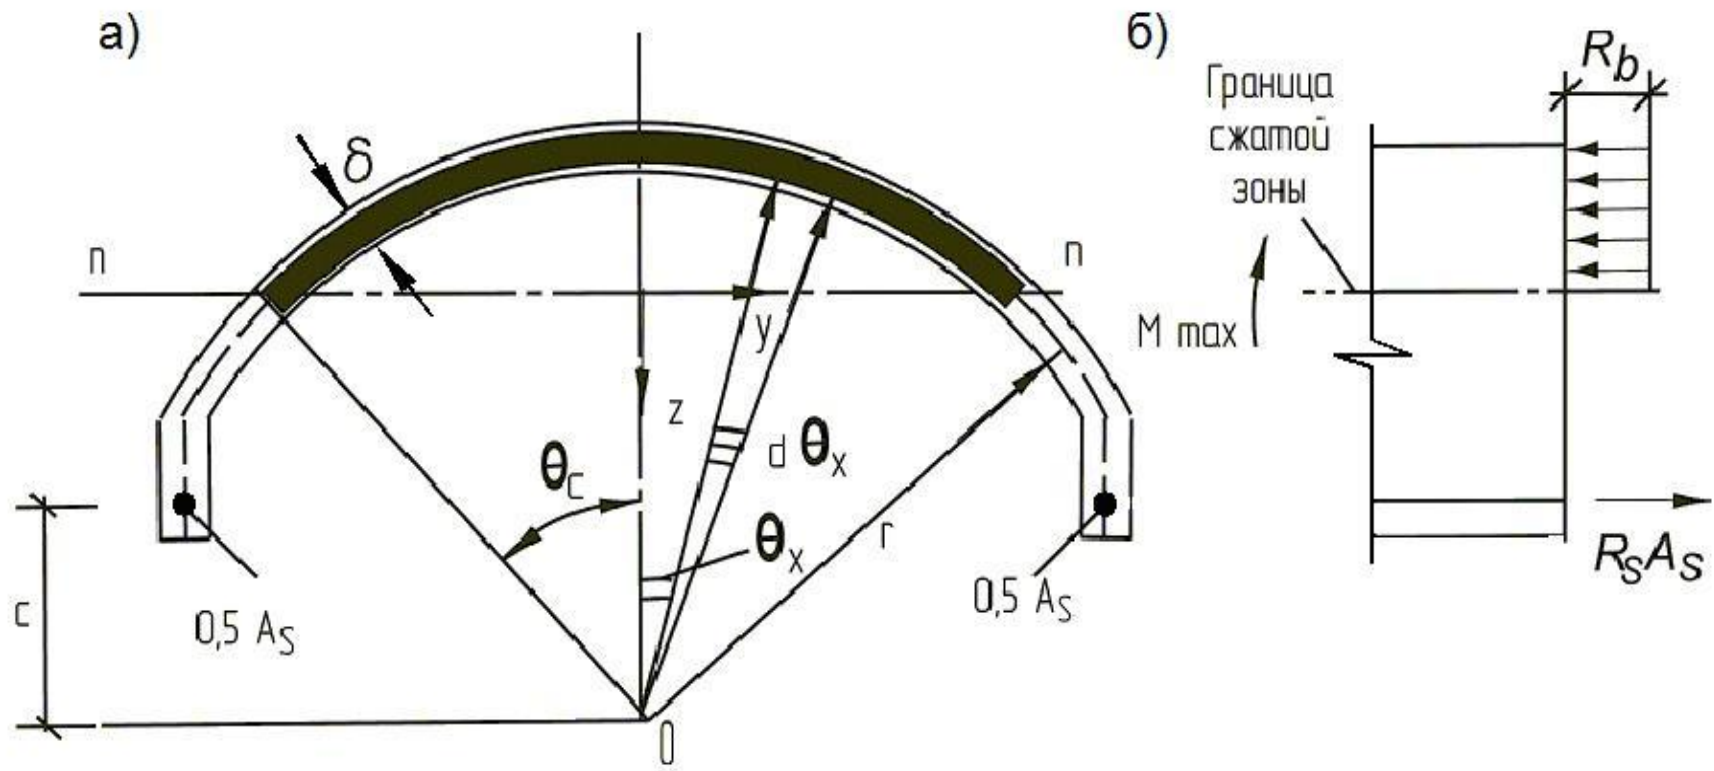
К расчёту цилиндрической оболочки по стадии предельного равновесия как железобетонной балки
